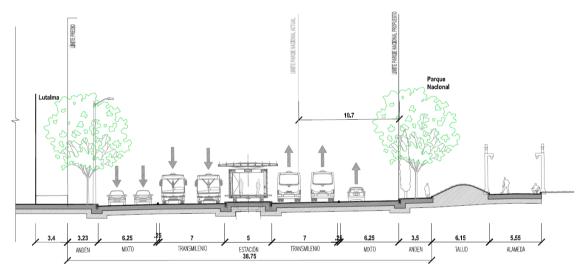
Perfil Actual Carrera 7ª (Av. Alberto Lleras Camargo) Tipo V-3.
